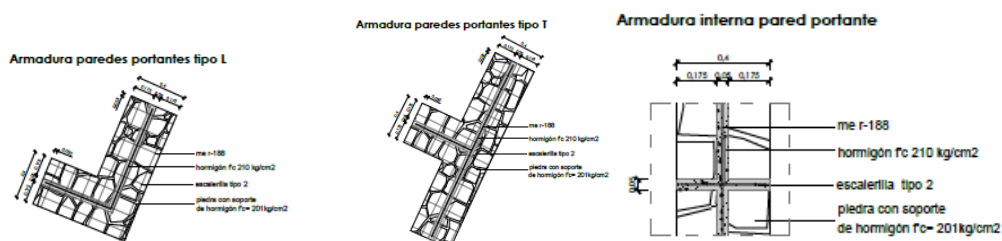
Armadura paredes tipo L Fuente: Cristian Campaña, 2018
